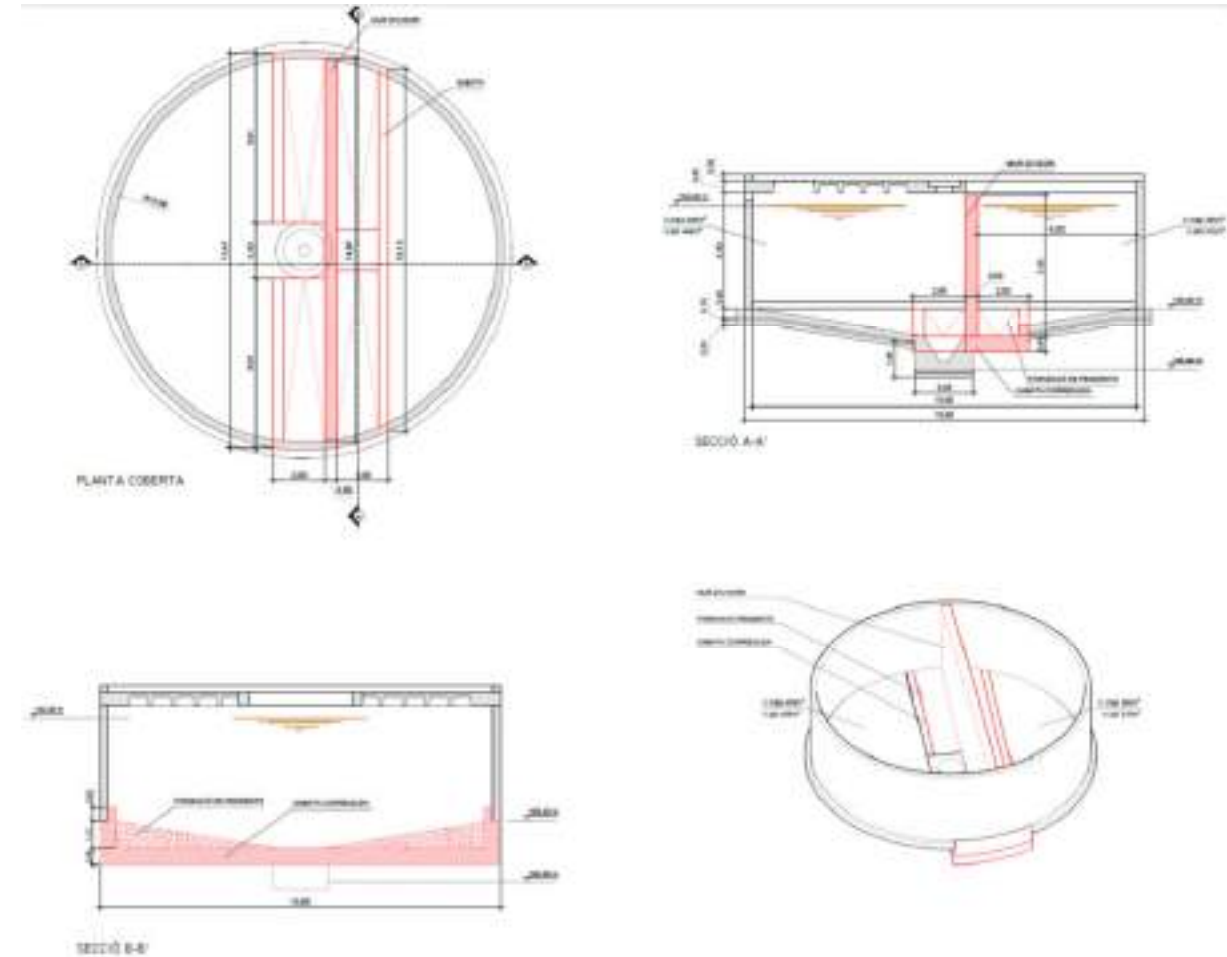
Detalls en planta i secció de l'alçat del mur divisor
